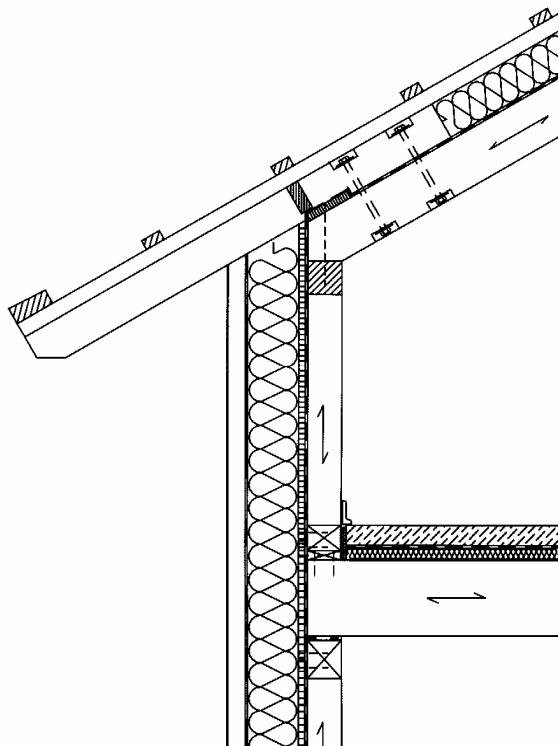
Dachdetail (First und Traufe) aus [68], S. 20
